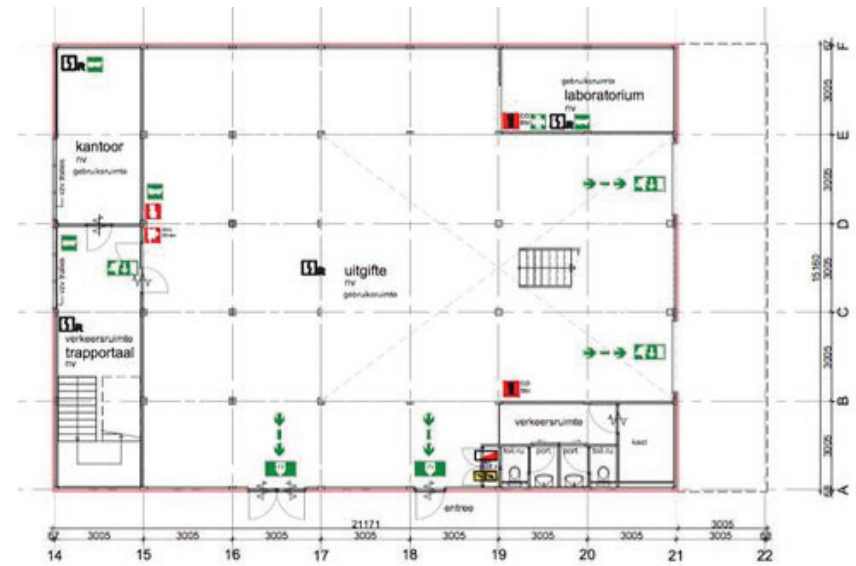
Pianta piano terra (Villa Camera); Fonte: <http://xxarchitekten.nl/>;
